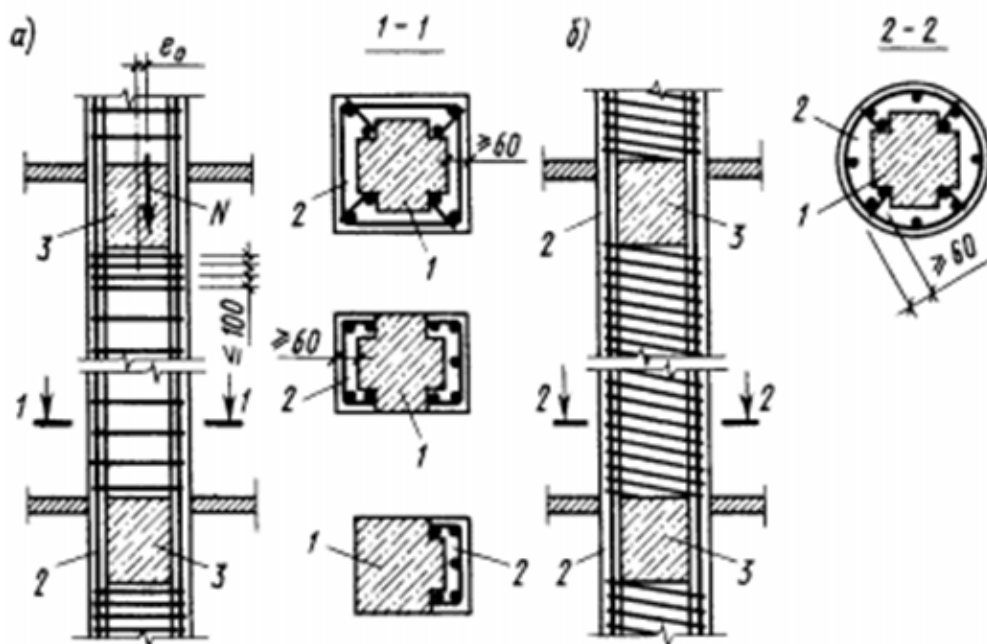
Підсилення залізобетонних колон обоймою з поздовжньою (а) і спіральною (б) арматурою:
